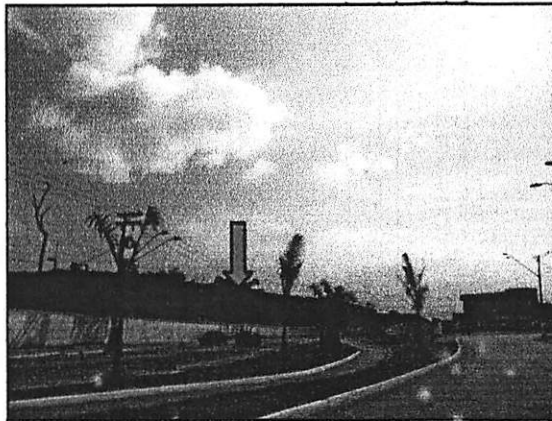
Observador na Av. do Trabalhador com vista para o aterro sanitário do "Lixão" onde se situa os lotes em estudos
